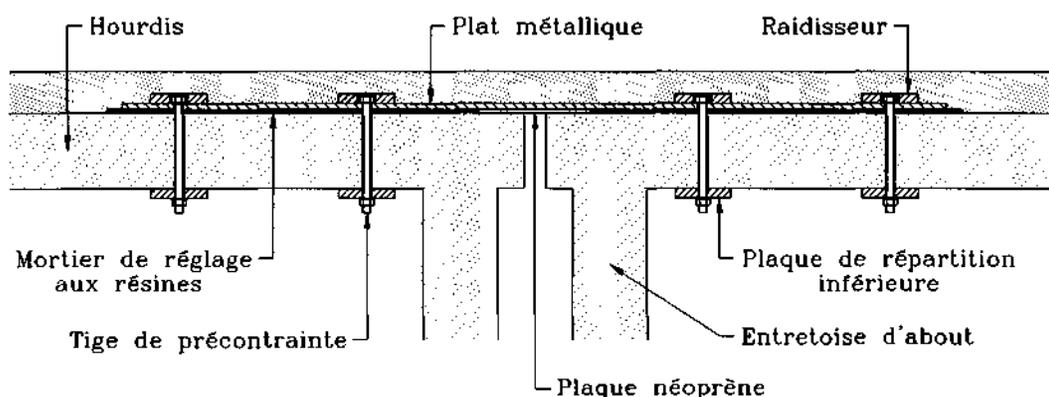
Exemple d'attelage par plats métalliques boulonnés
